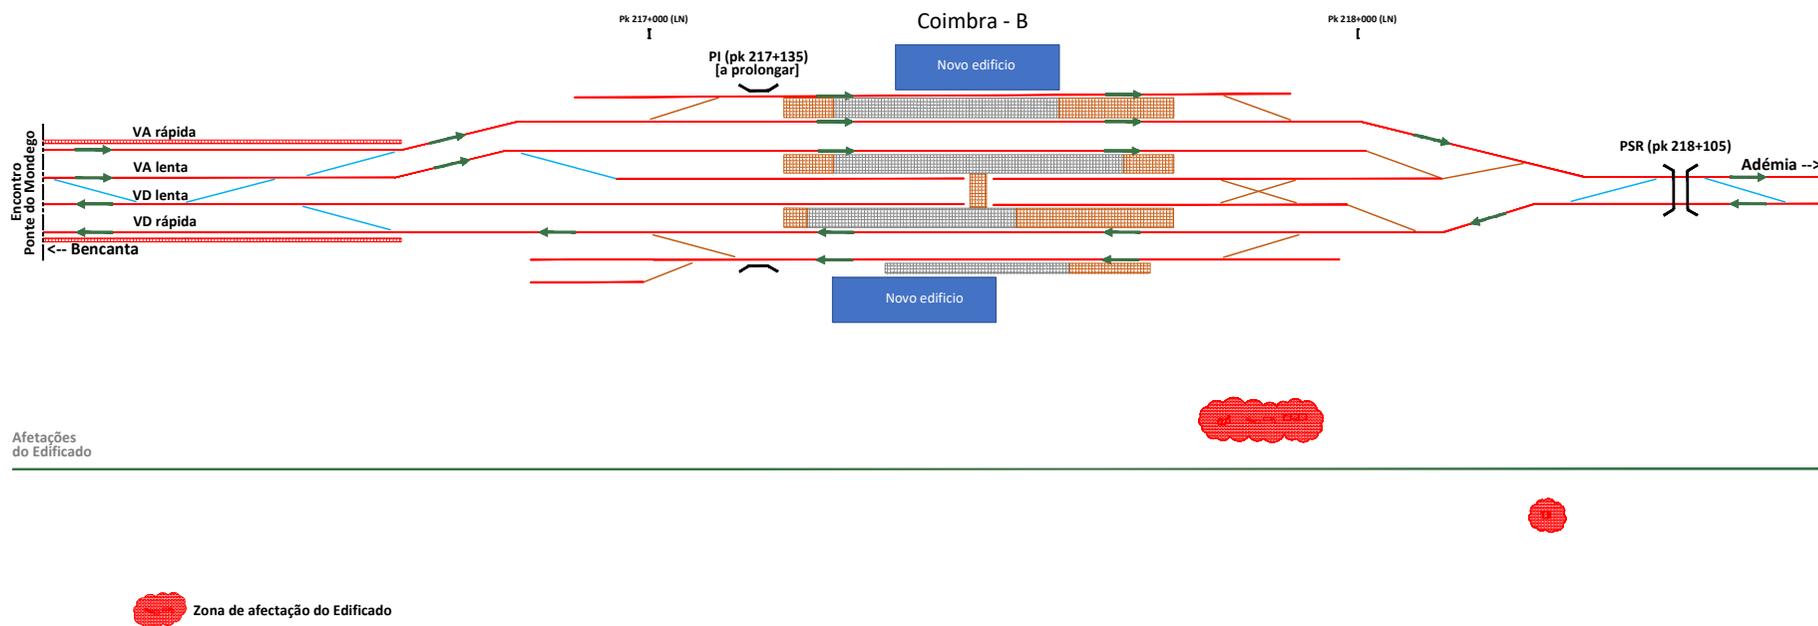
Esquema de Localização do edificado afetado na zona da Estação de Coimbra B
